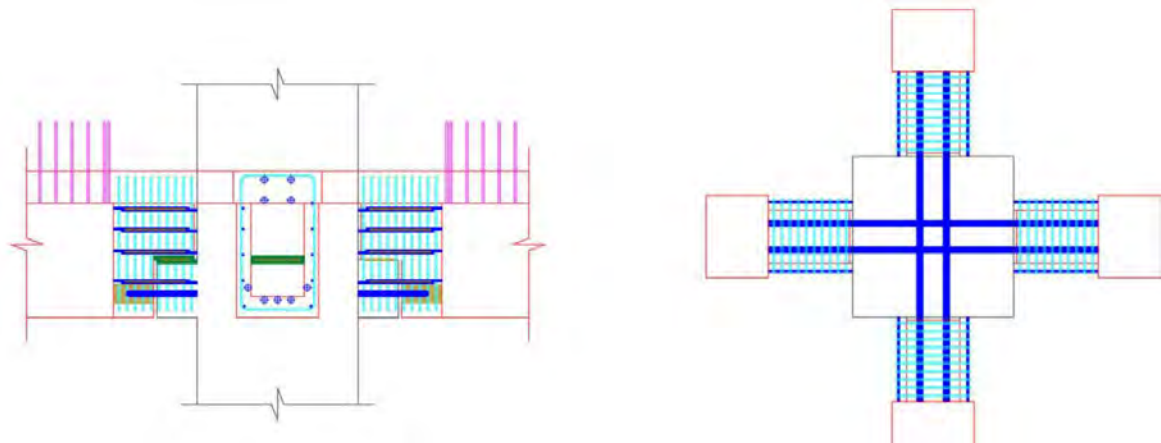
Detalles de conexión soldada en un elemento prefabricado.
